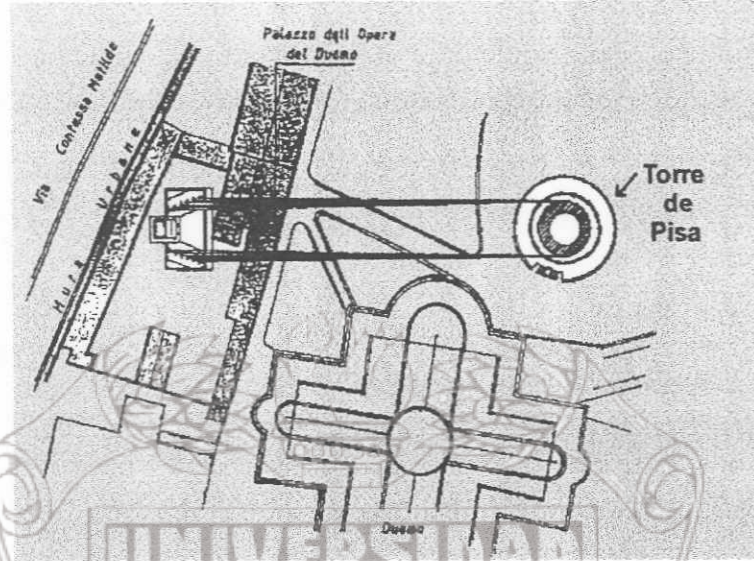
Planta de la Torre de Pisa y el anclaje a la estructura de concreto.
